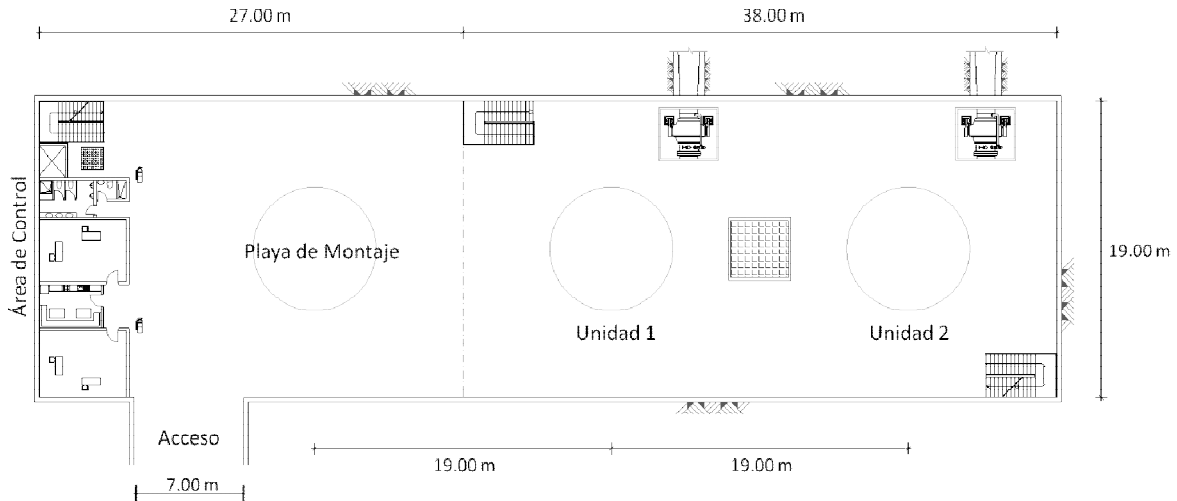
Planta piso de excitadores. Elevación 291,16 msnm
